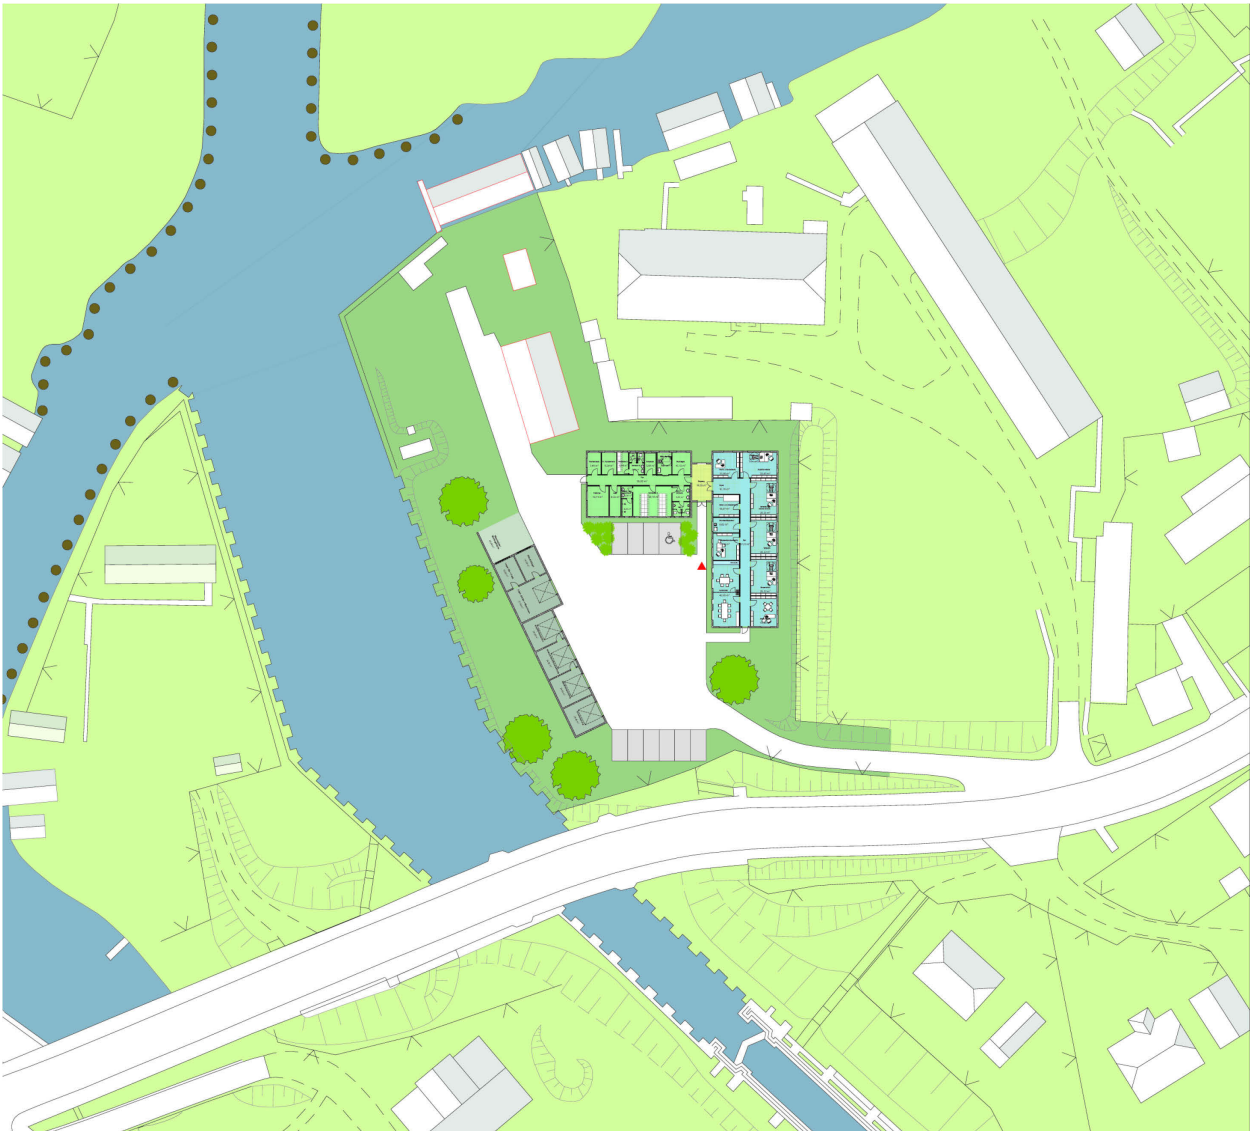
Lageplan für das Grundstück mit aktueller Bebauung
